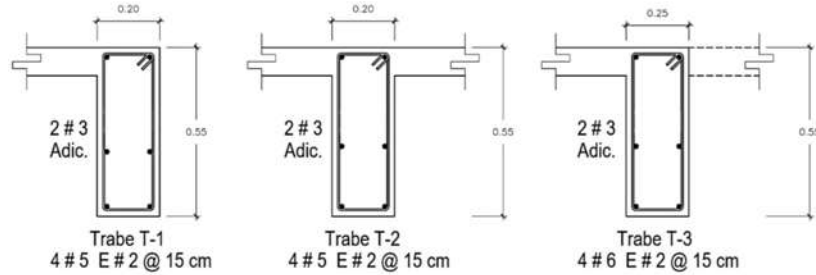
Secciones transversales y detallado del acero de refuerzo longitudinal y transversal de las traves del edificio de 3 niveles (Tomado de: Olvera, 2020).
